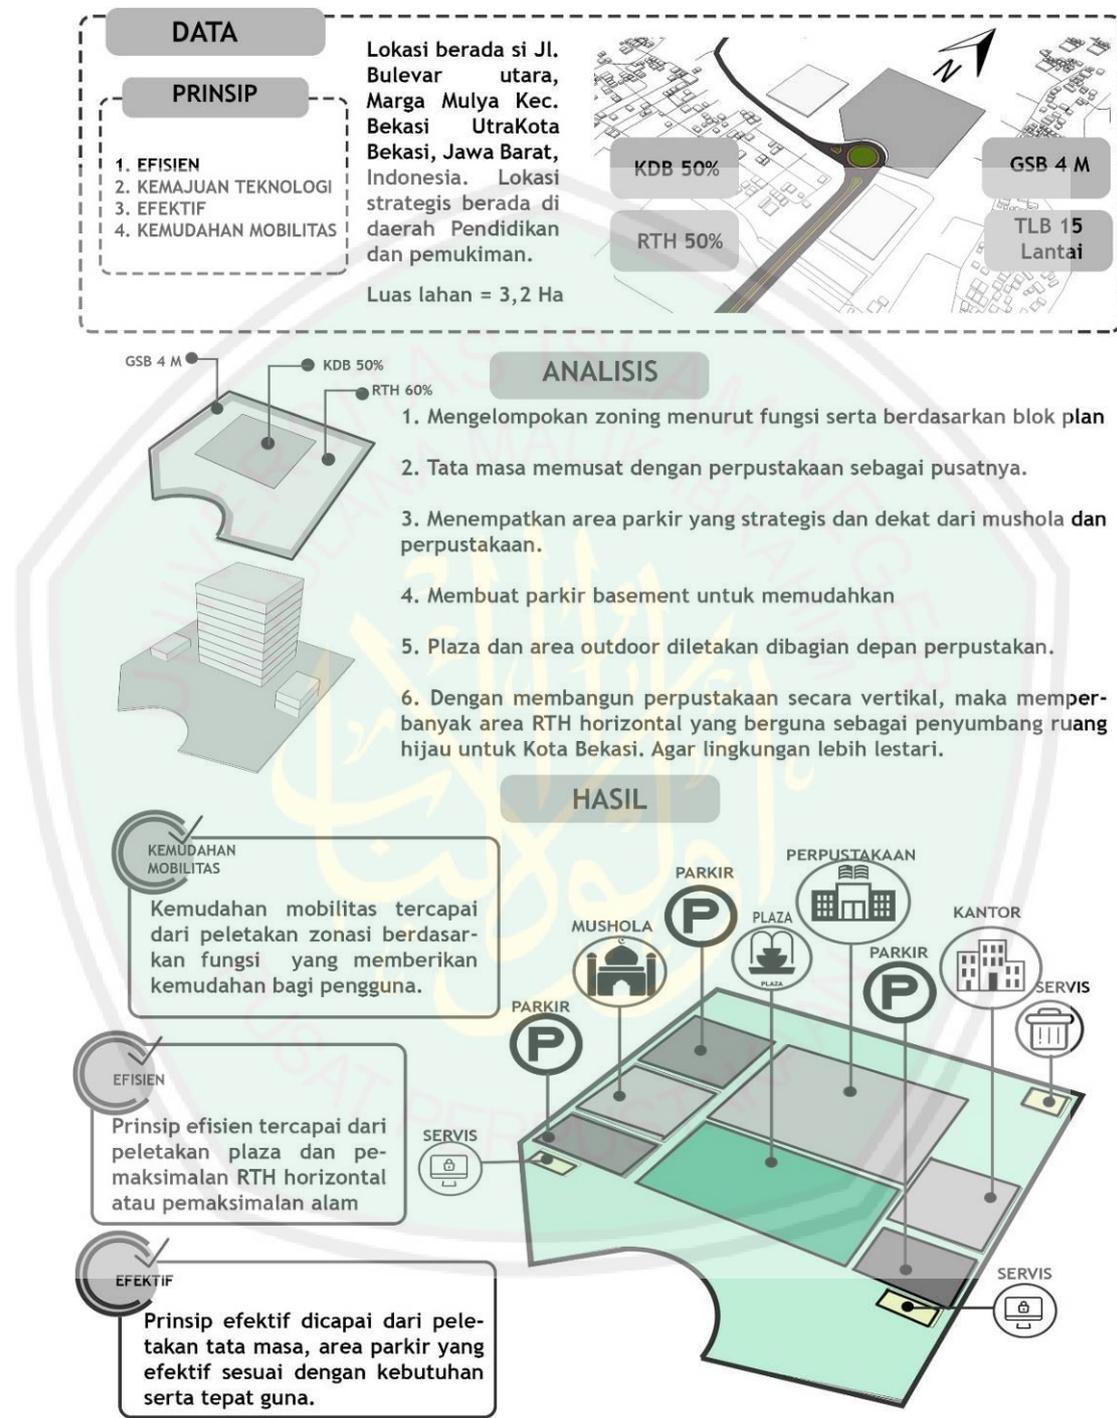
Hubungan Ruang dan Blok Plan Mushola
